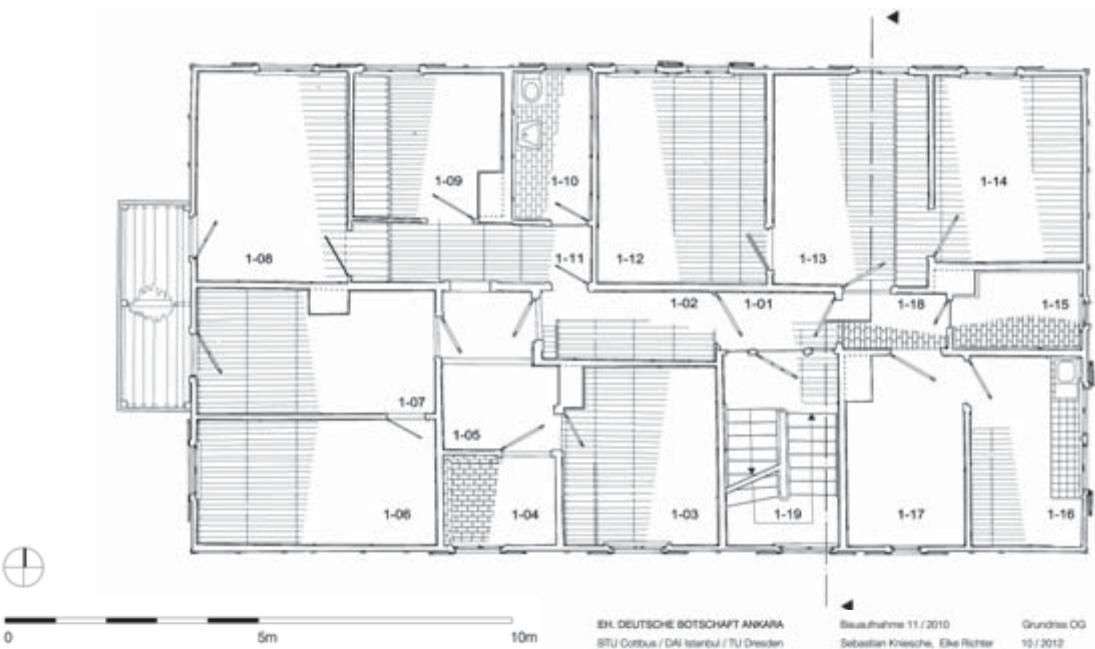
Ankara, eh. Deutsche Botschaft, Grundriss Obergeschoss, Bauaufmaß 2010
